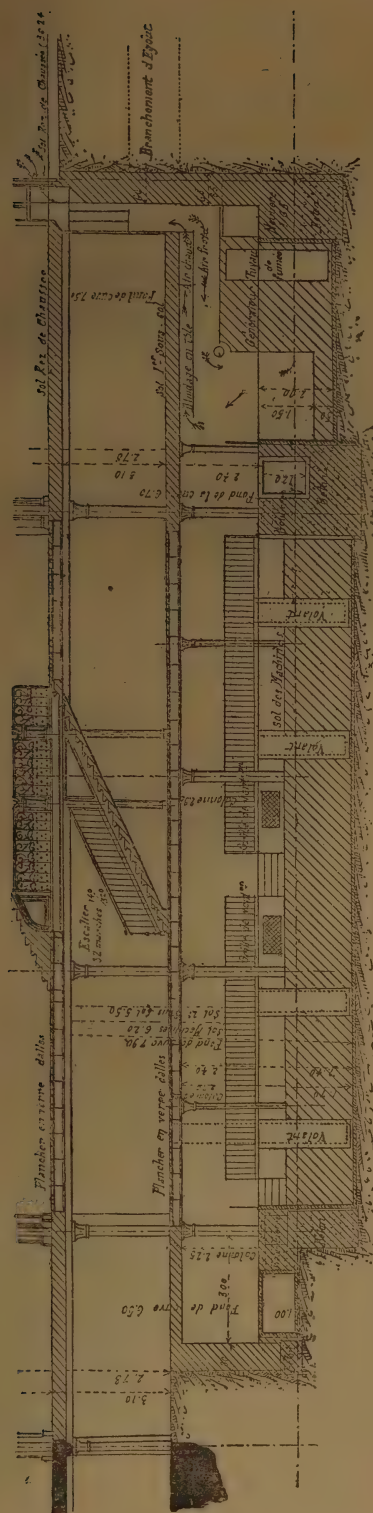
Fondations du Bon-Marché. — Coupe longitudinale, montrant le caisson de la machinerie vu de face et le caisson de la chaufferie vu en bout.
